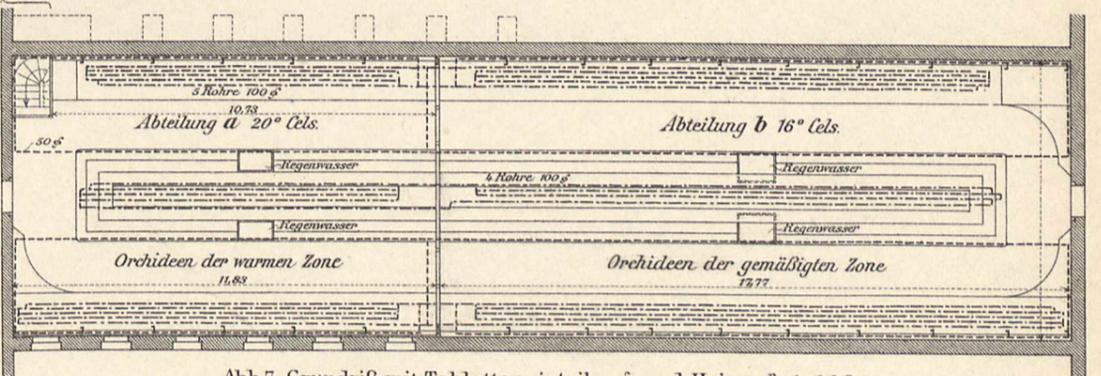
Grundriß mit Tabletteneinteilung und Heizung. 1:200.
